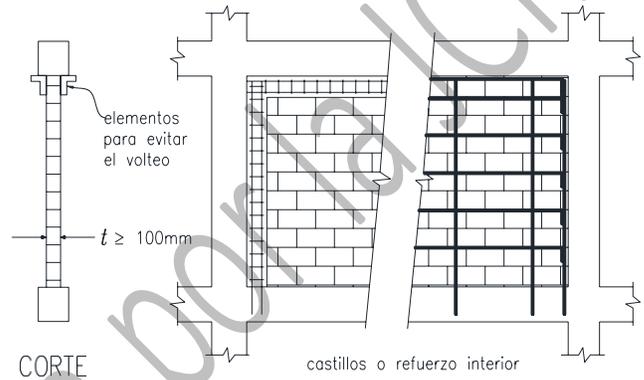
Ejemplos esquemáticos de detallado de muros diafragma
